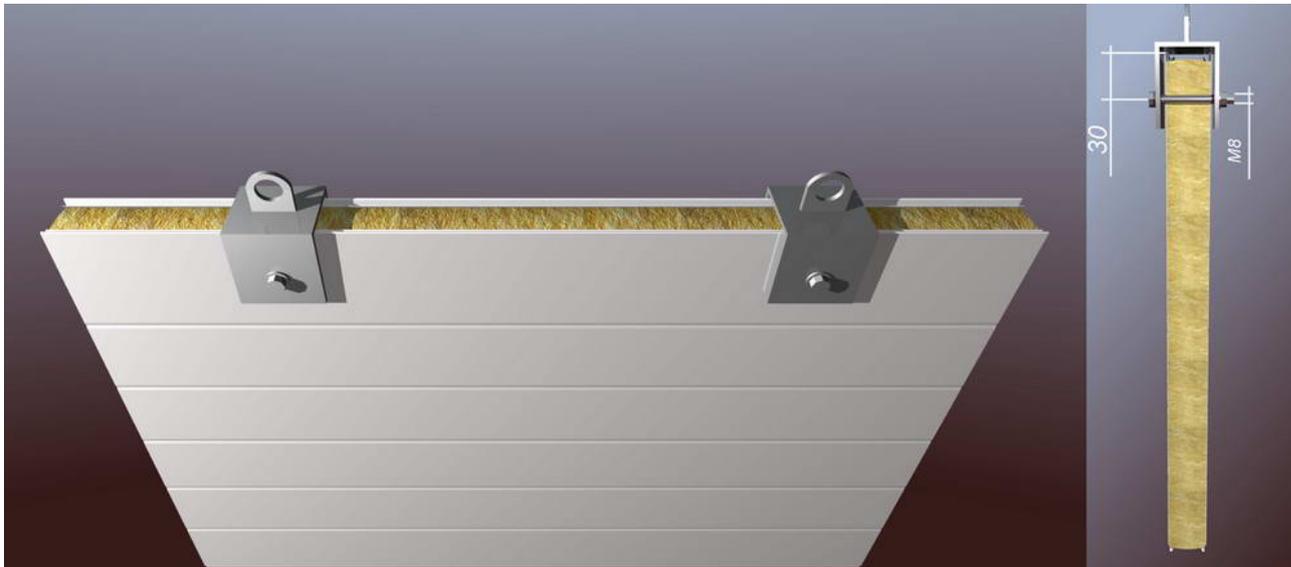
а – Транспортирование и укладка стеновых панелей на месте монтажа
